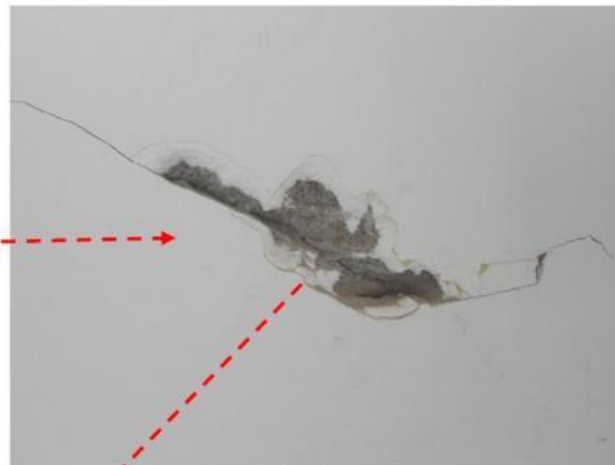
Detalhe 2 da fissuração no quarto.
